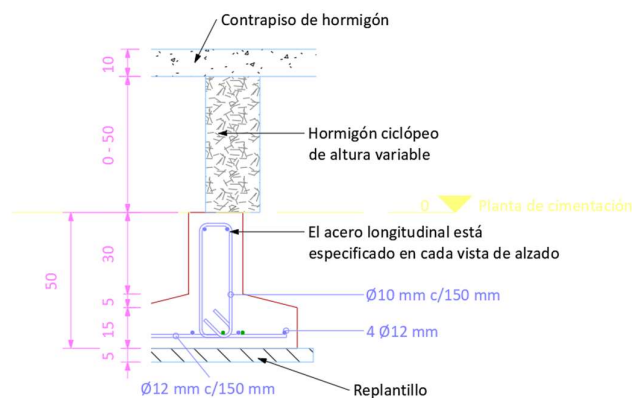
Sección de Zapatas (Boza y D'Steffano, 2023)
